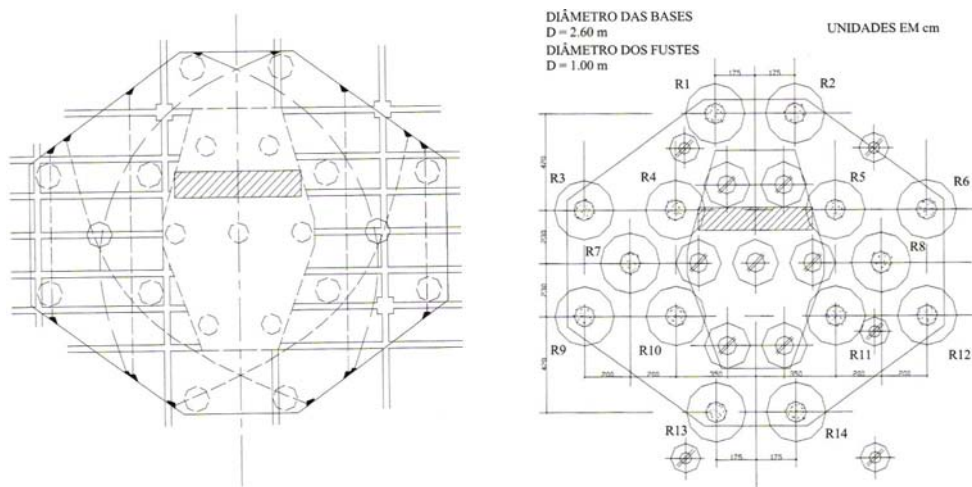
Planta do conjunto das fundações originais e reforço (Fonte: Veloso, Naegueli e Videira; Capítulo 9, Acidentes Estruturais na Construção Civil, 1998).
